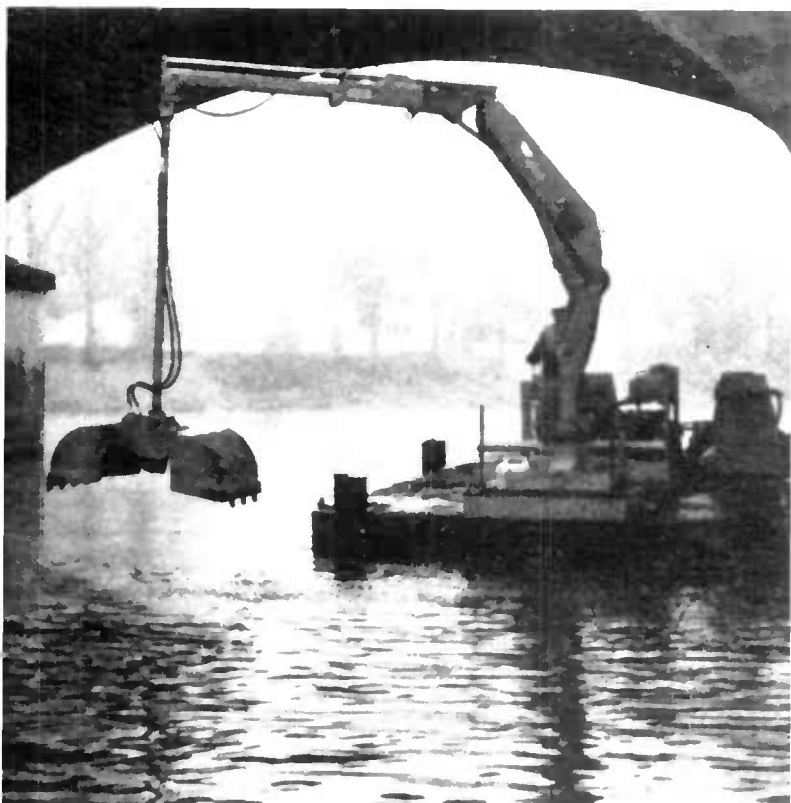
Pelle hydraulique montée sur un ponton flottant.
